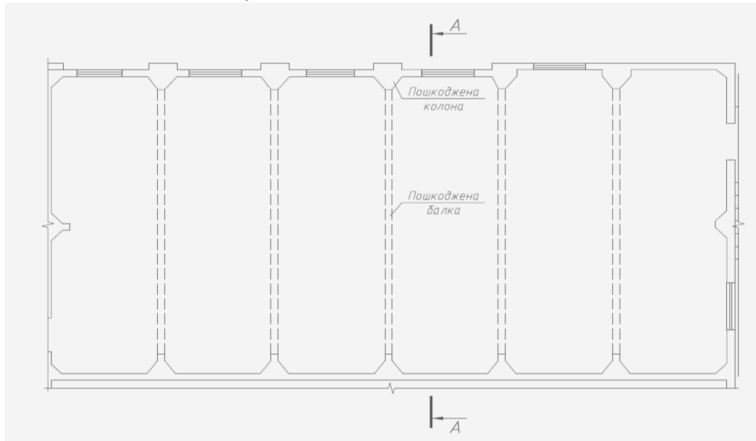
Фрагмент плану міжповерхового перекриття з зазначенням розташування найбільш пошкоджених конструкцій
